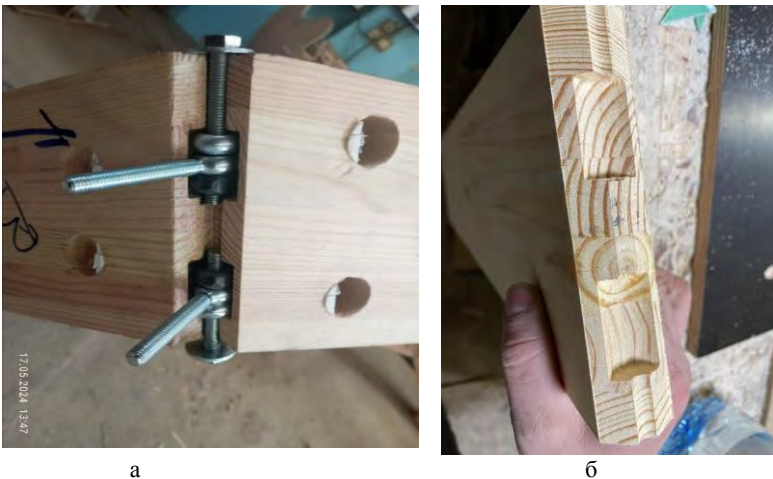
а - вузол з двома конекторами; б – відфрезерований торець елемента
